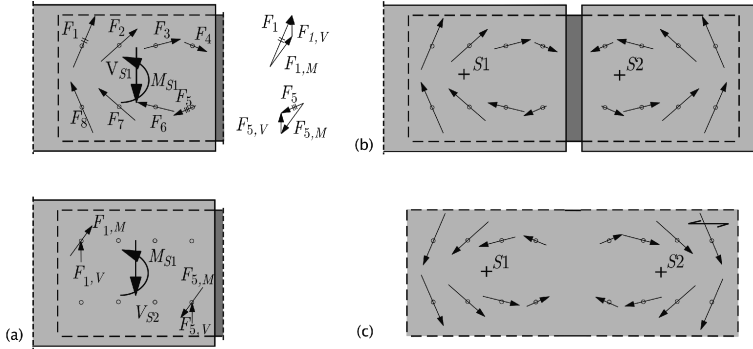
Biegesteifer Balkenstoß mit eingeschlittem Stahlblech: (a) Vektoraddition der Kräfte an den Verbindungsmitteln, (b) Anschlusskräfte am Holz und (c) Kräftegleichgewicht am Stahlblech.
